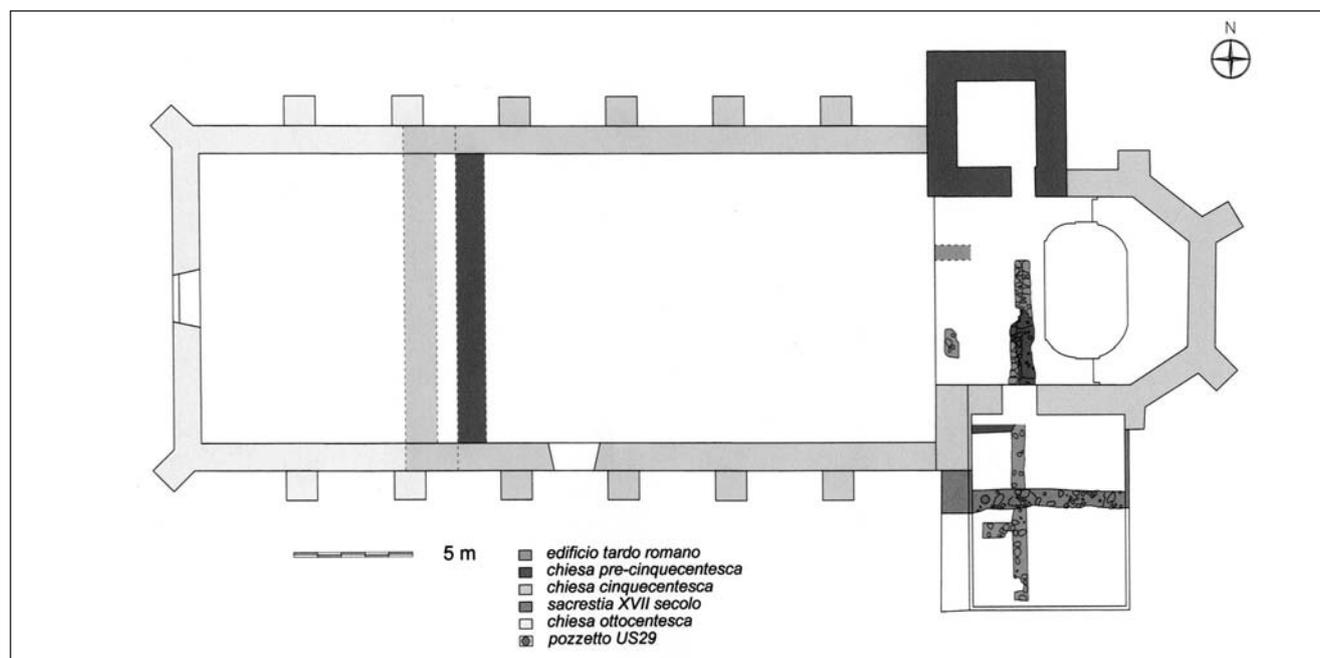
Planimetria della chiesa di S. Maria Assunta di Cles
